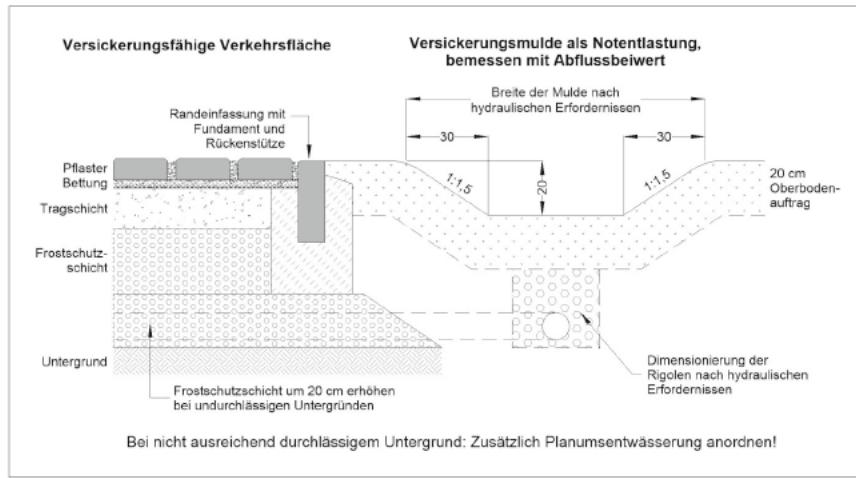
Regelaufbau für eine versickerungsfähige Verkehrsfläche mit Betonpflasterdecke
